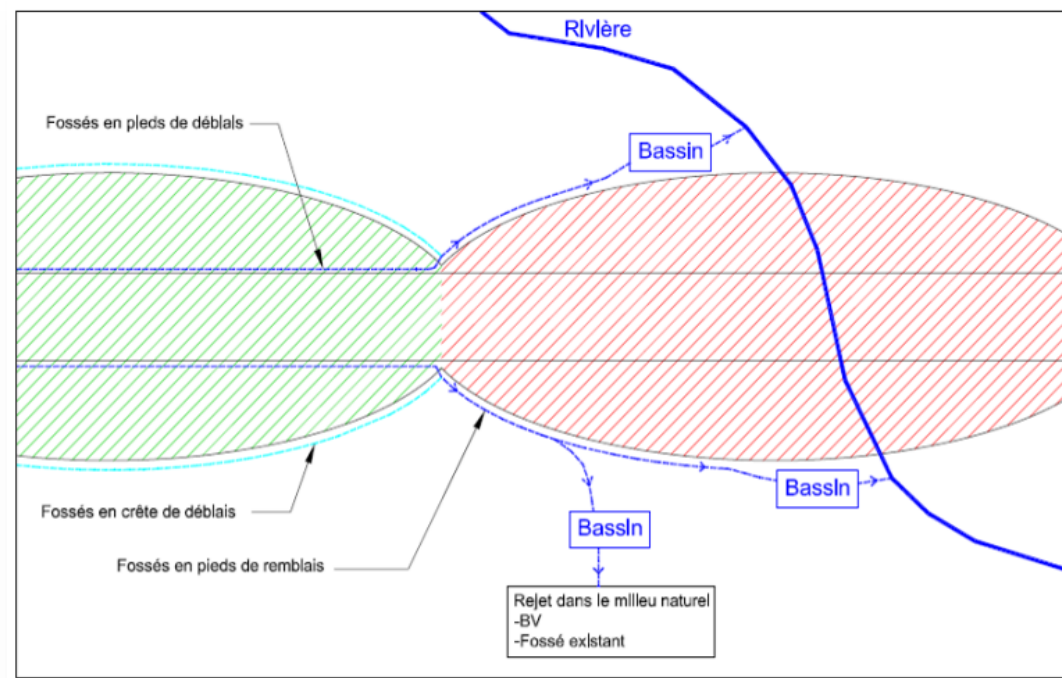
Schéma de principe de collecte des eaux en phase travaux
